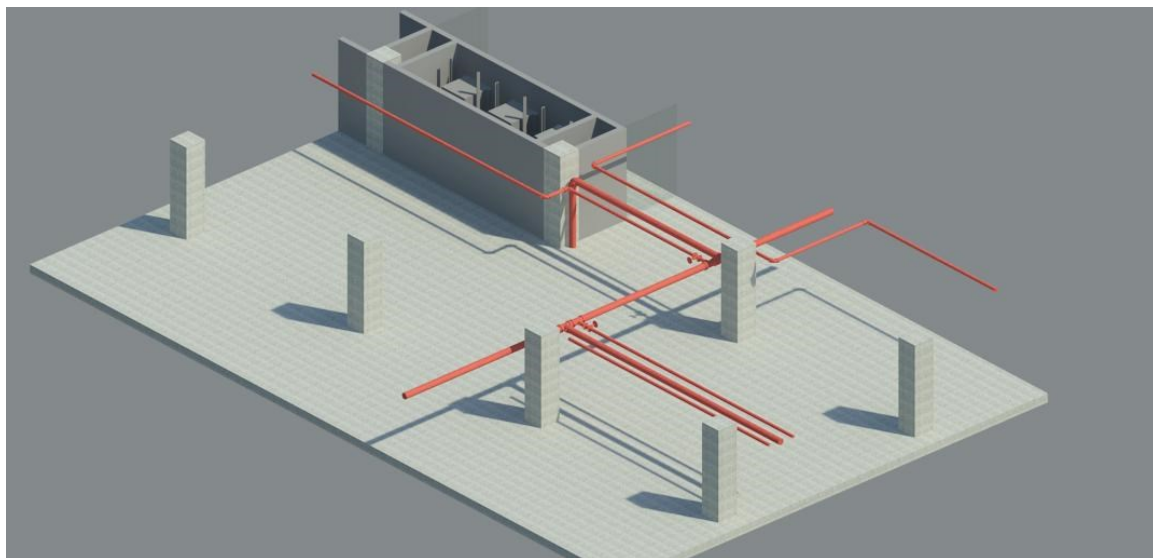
Pormenor de Traçado A (Piso -1)
